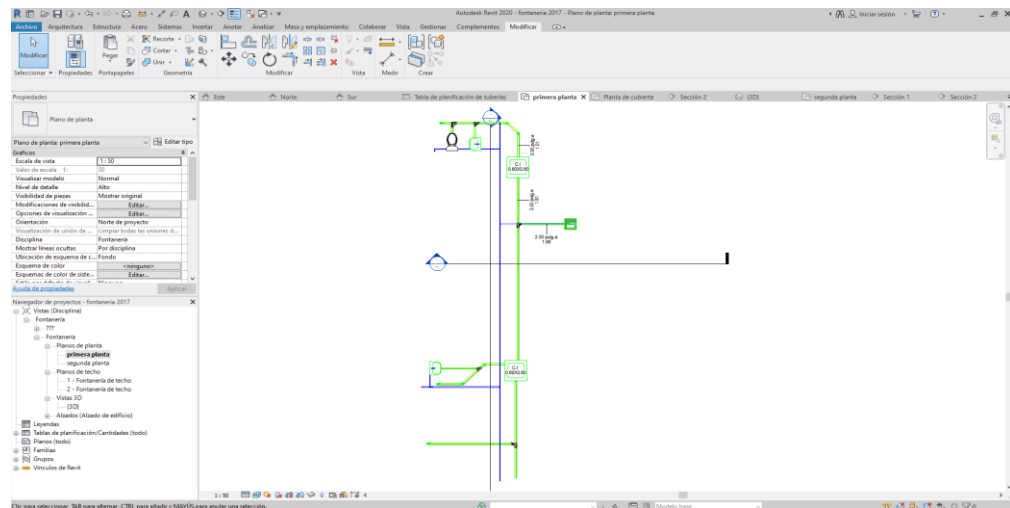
Primera Planta Plano Hidráulico sanitario. Revit. Fuente elaboración propia.
